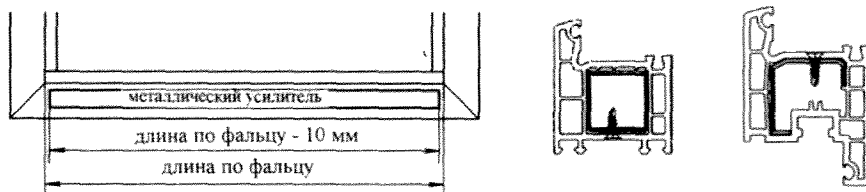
Установка металлического усилителя в оконный профиль из ПВХ
